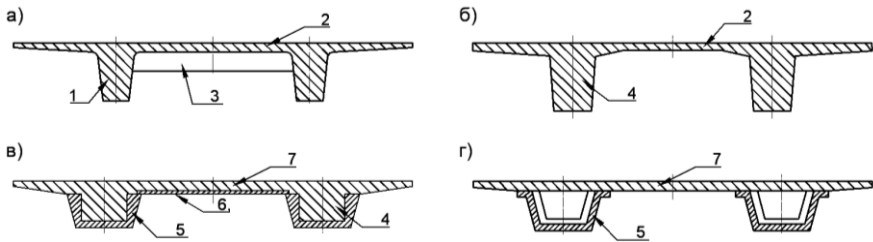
Поперечні перерізи двобалкових нерозрізних залізобетонних прогонових будов мостів: а – збірні блоки типу ПРК; б – монолітна двобалкова конструкція; в – збірно-монолітна двобалкова конструкція; г – збірно-монолітна коробчаста конструкція; 1 - головні балки; 2 - плита проїзної частини; 3 – поперечна балка; 4 – монолітна головна балка; 5 – збірні балки типу «U»; 6 – плоска збірна плита; 7 – монолітна плита проїзної частини
